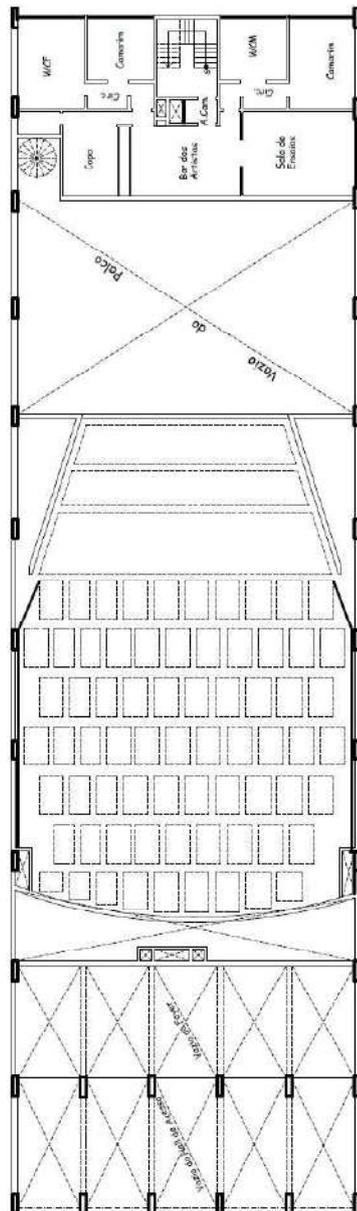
Planta do 4º Pavimento, reprodução das plantas com o projeto original de Raphael Matheus Peres, fonte: Funarj, edição: Delano Delfino.
